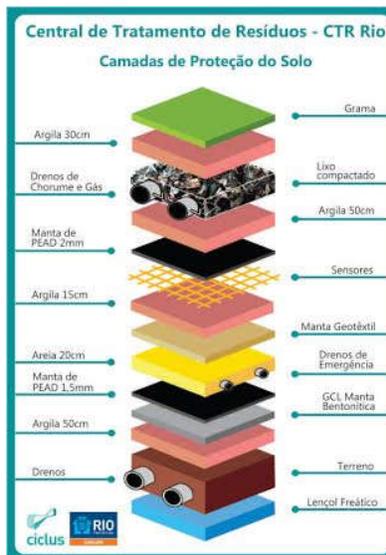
Perfil das Camadas de Impermeabilização adotado no aterro sanitário da CTR-Rio .
